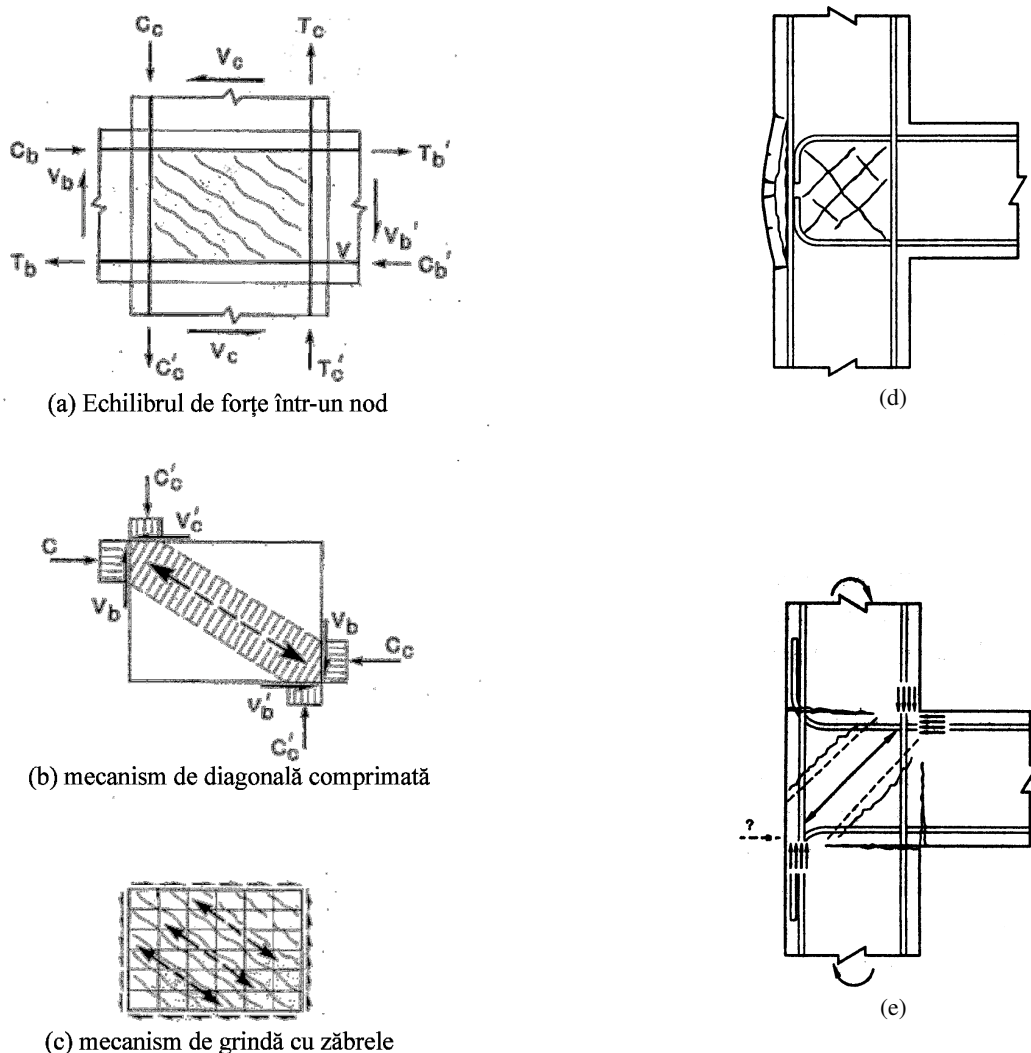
Starea de eforturi și mecanismele de preluare a forței tăietoare într-un nod (a, b, c) - Derecho și Kianoush, 2001; detalierea armăturilor longitudinale din riglă pentru asigurarea mecanismului de diagonală comprimată (d, e) - Priestley, 1997.
